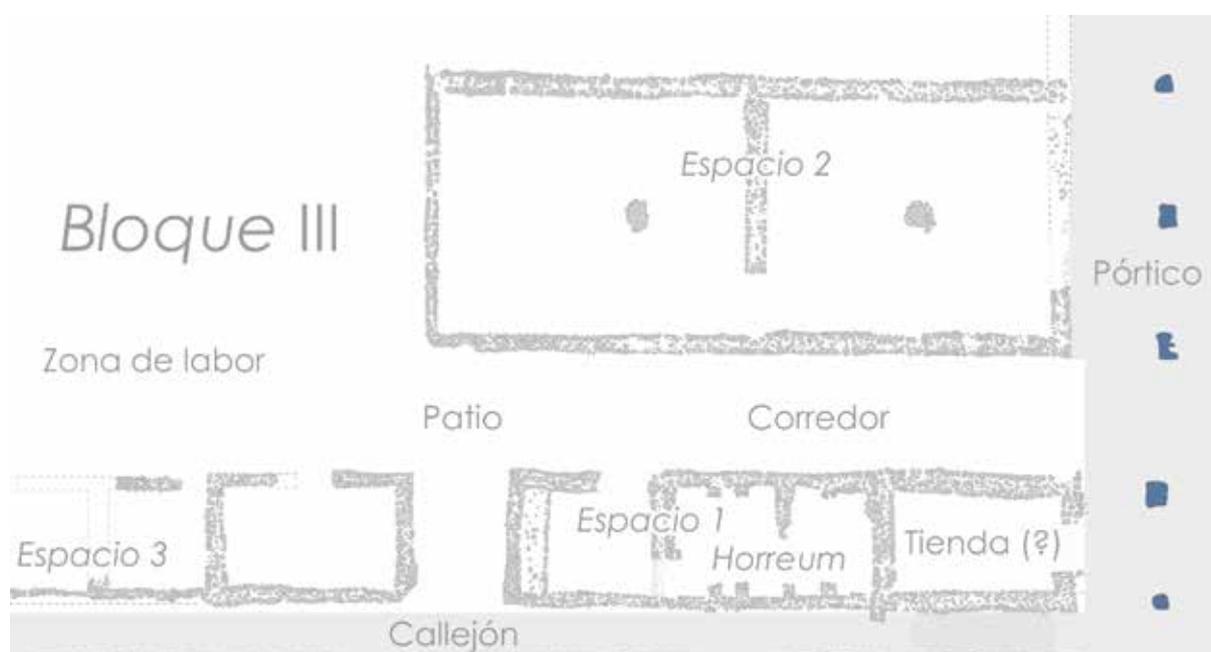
Detalle del Bloque Constructivo III en la Primera fase constructiva (modificado a partir de planimetría de J. C. Álvarez Ordas).
